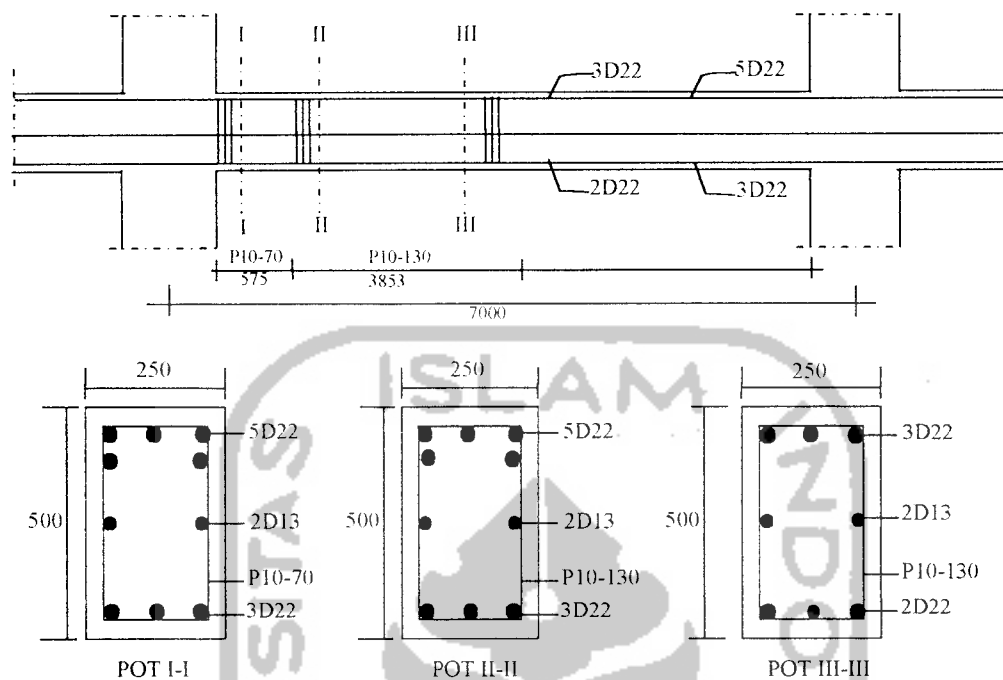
Balok Portal E Bentang 7 m Lantai 4
